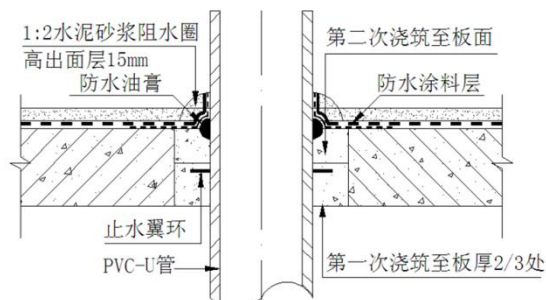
给排水管道和采暖管道系统穿楼板做法示意图（有水房间）
